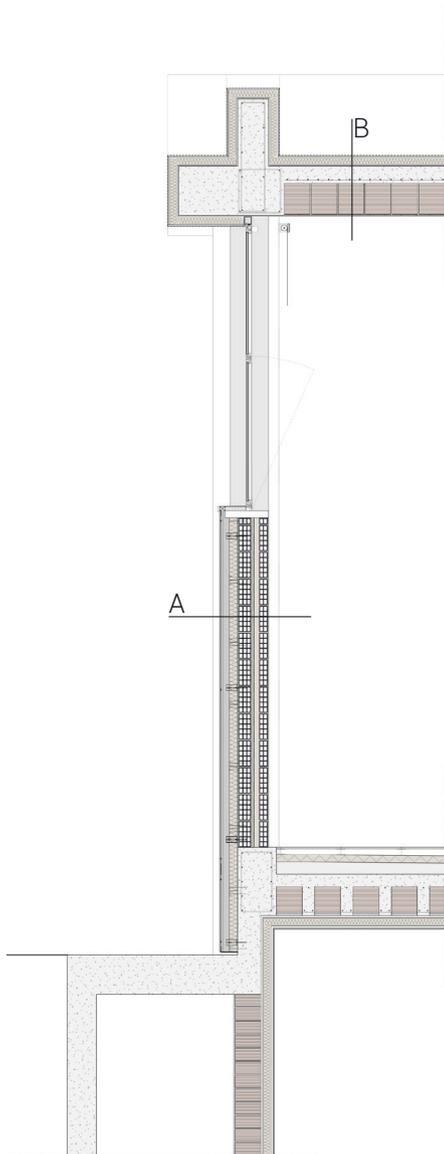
Pianta prospetto sezione dell'intervento di retrofit
